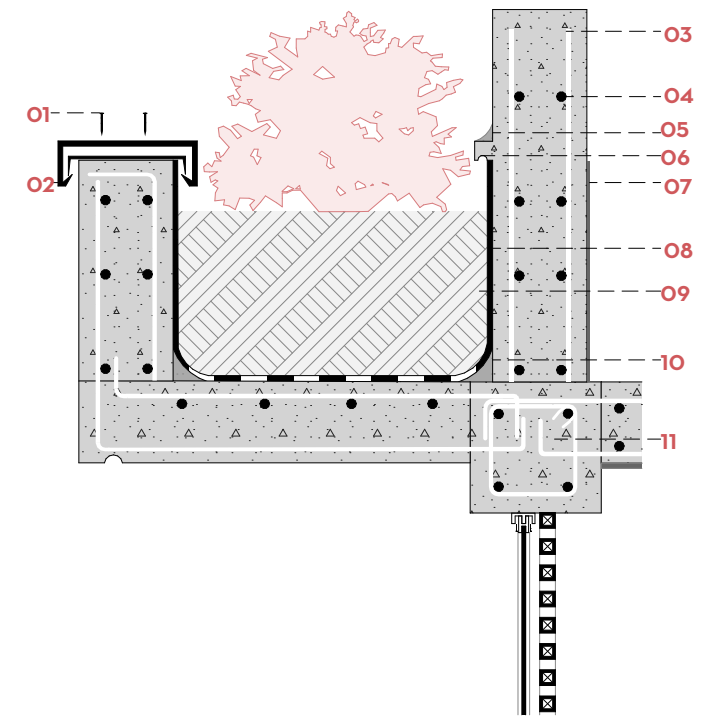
Detalle constructivo O6. Fuente: Autoría propia.
